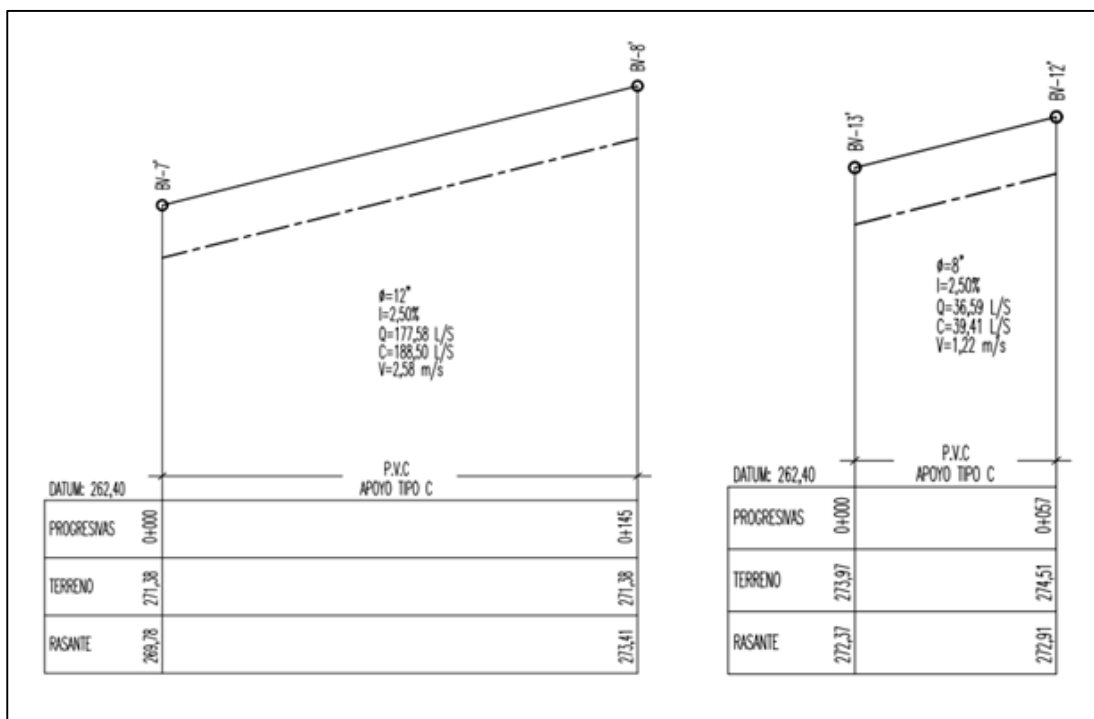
Perfiles de alcantarillado para propuesta de desvío.
